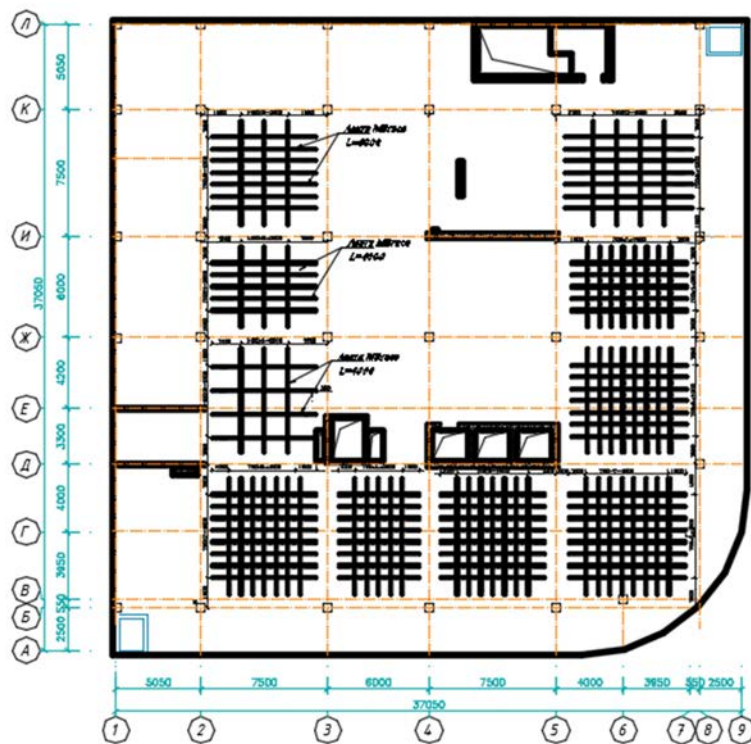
Схема расположения лент усиления на нижней поверхности плиты перекрытия над 2-ым этажом здания Бизнес-центра в г. Нур-султан
